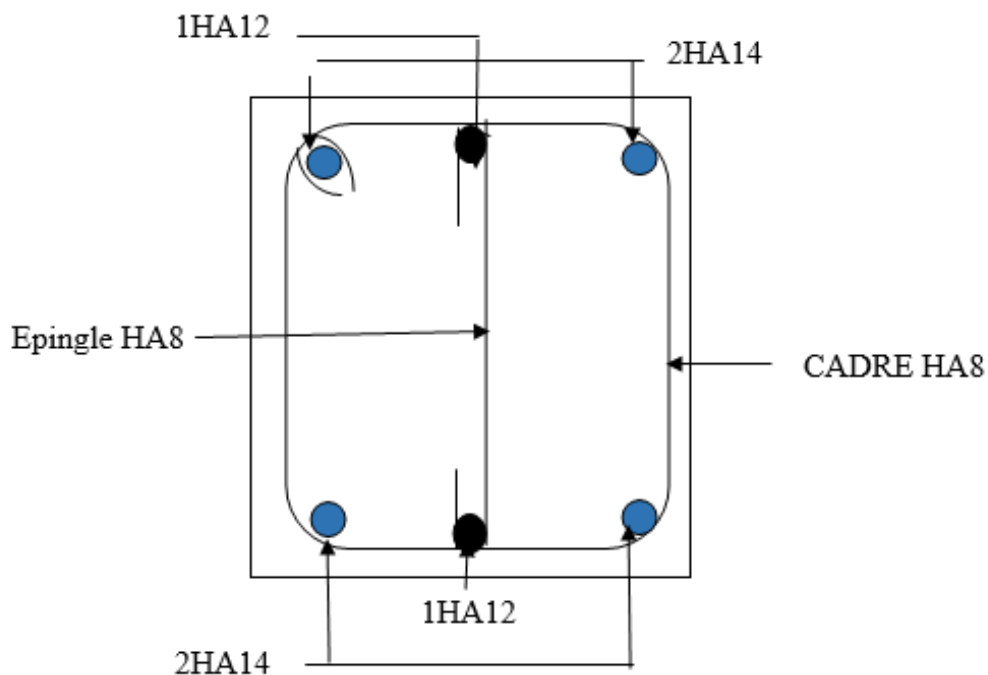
schema de ferrailage de la poutre de chaînage
